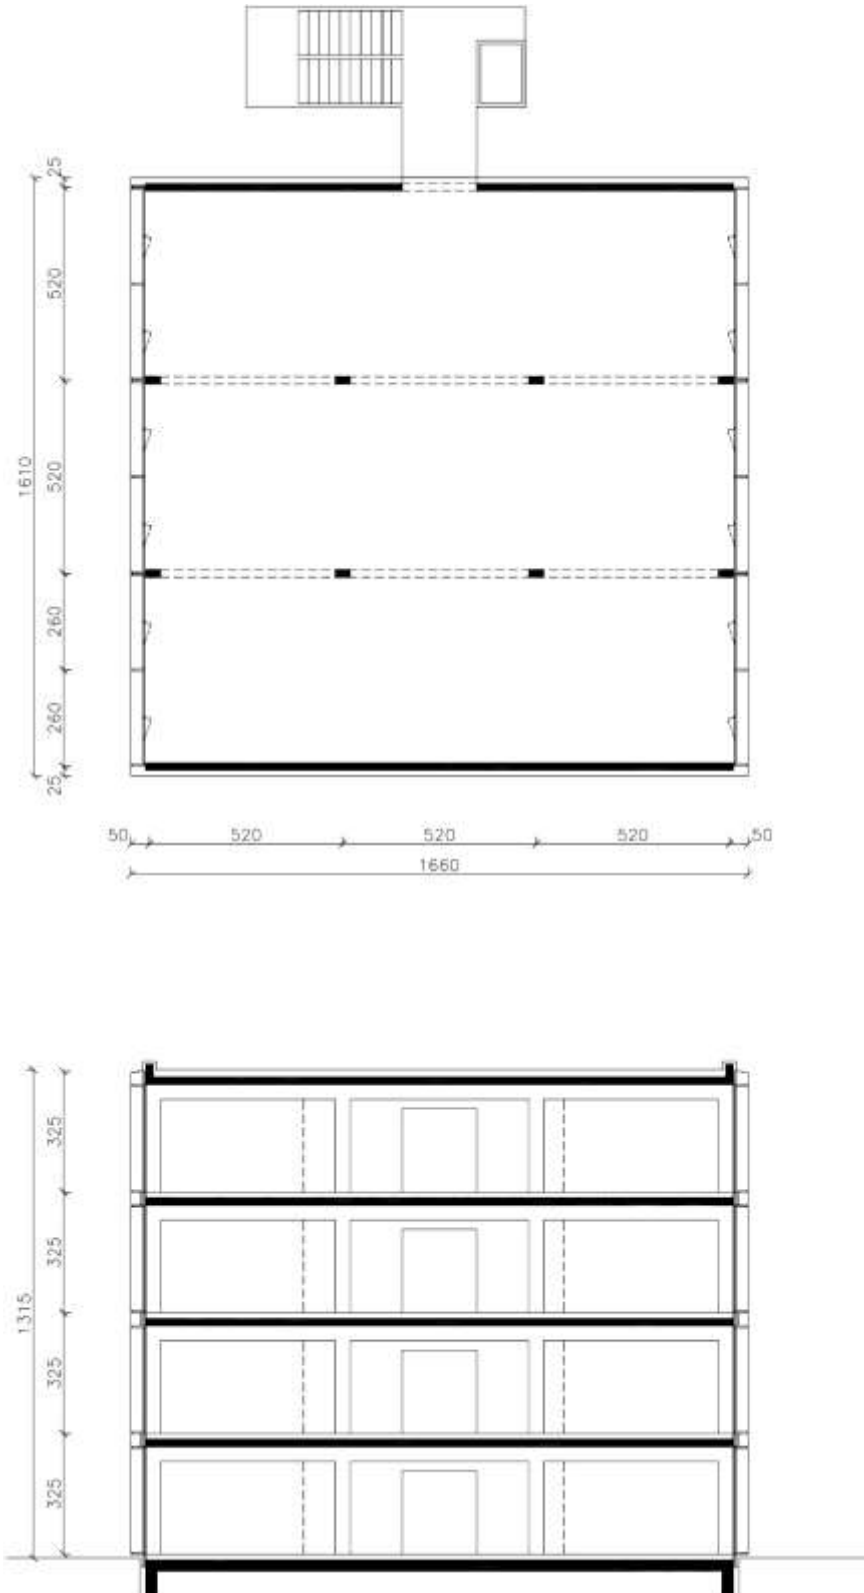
Grundriss und Schnitt [eigene Darstellung]
